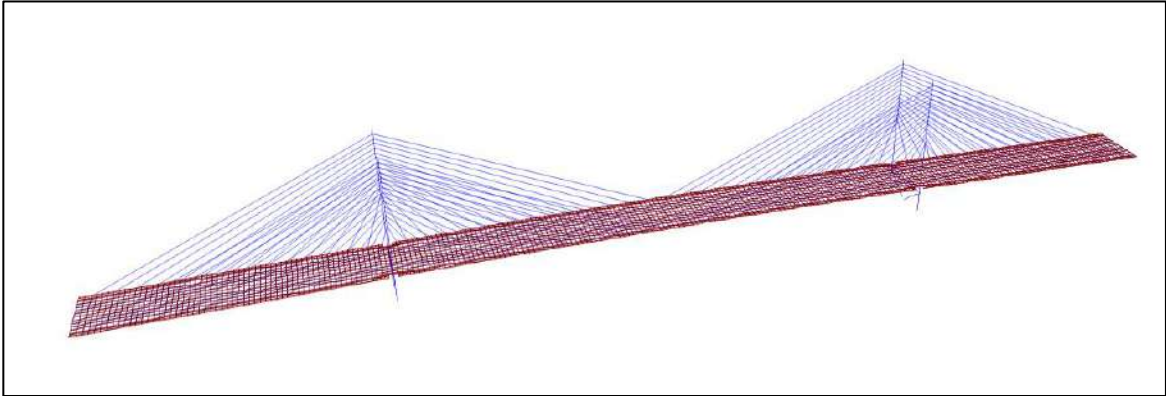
Modelo de elemento finito del puente Río Papaloapan.
